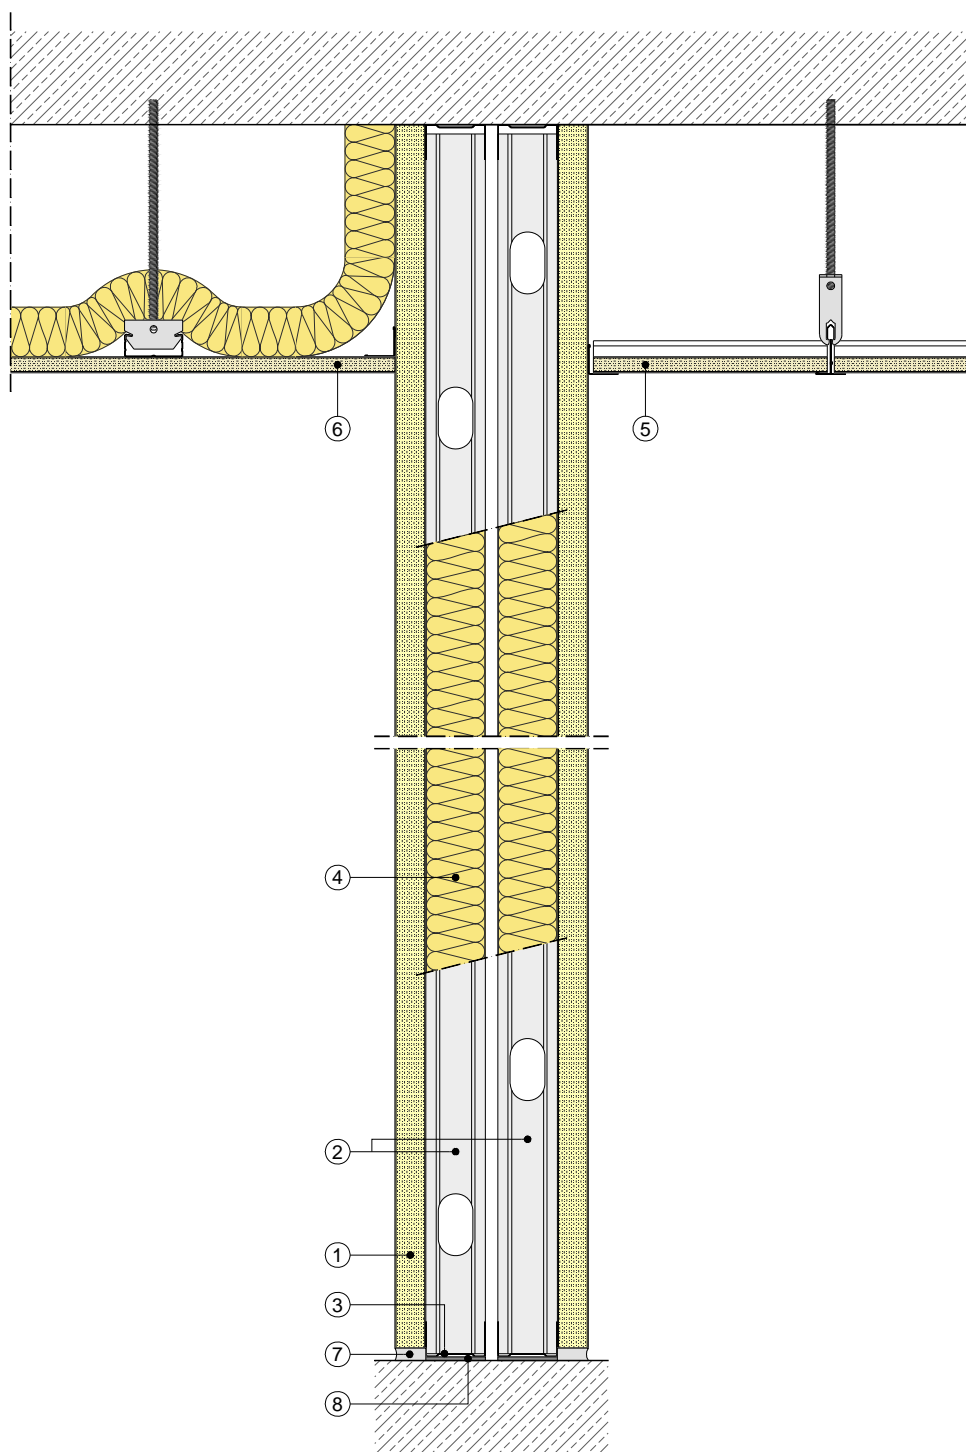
Raccordement de la cloison avec le plafond et le plancher
